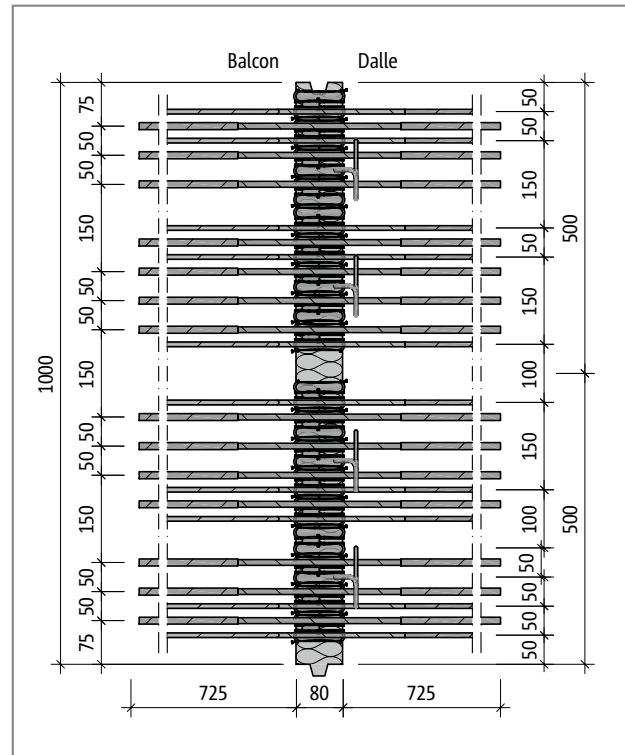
Schöck Isokorb® T Type K-T-M10-V1 : Plan de base du produit
